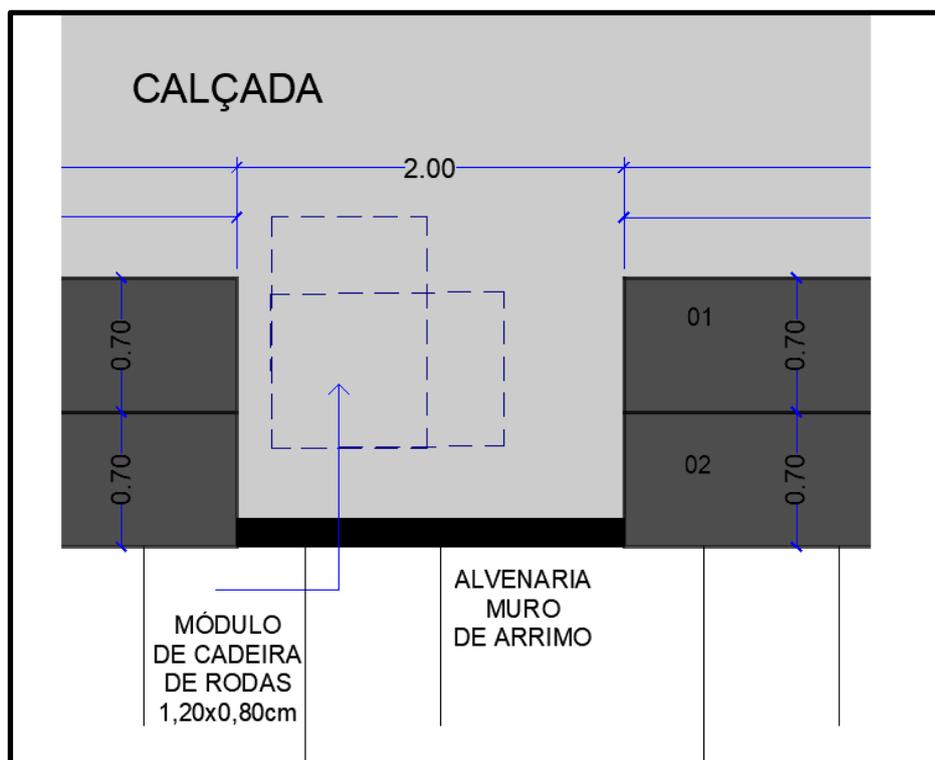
ESPAÇAMENTO ARQUIBANCADA DE CONCRETO- DETALHE RETIRADO DO PROJETO
